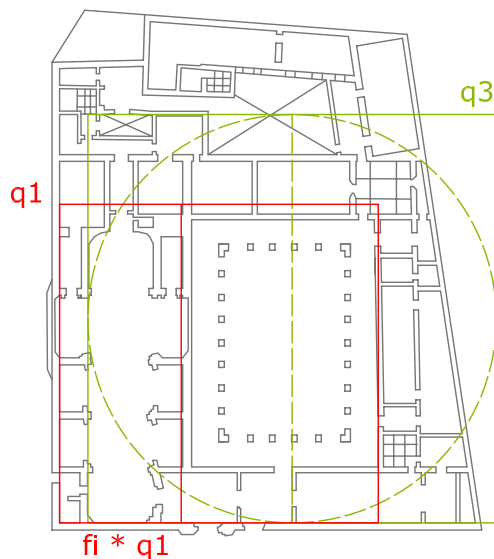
Trazado de la planta hipotética (9). [Fig. III.38] Trazado de la planta hipot. (10).
